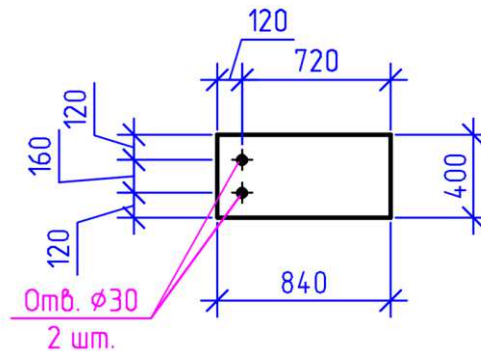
Фасонка, для болтового соединения элемента связей по нижнему поясу ферм
